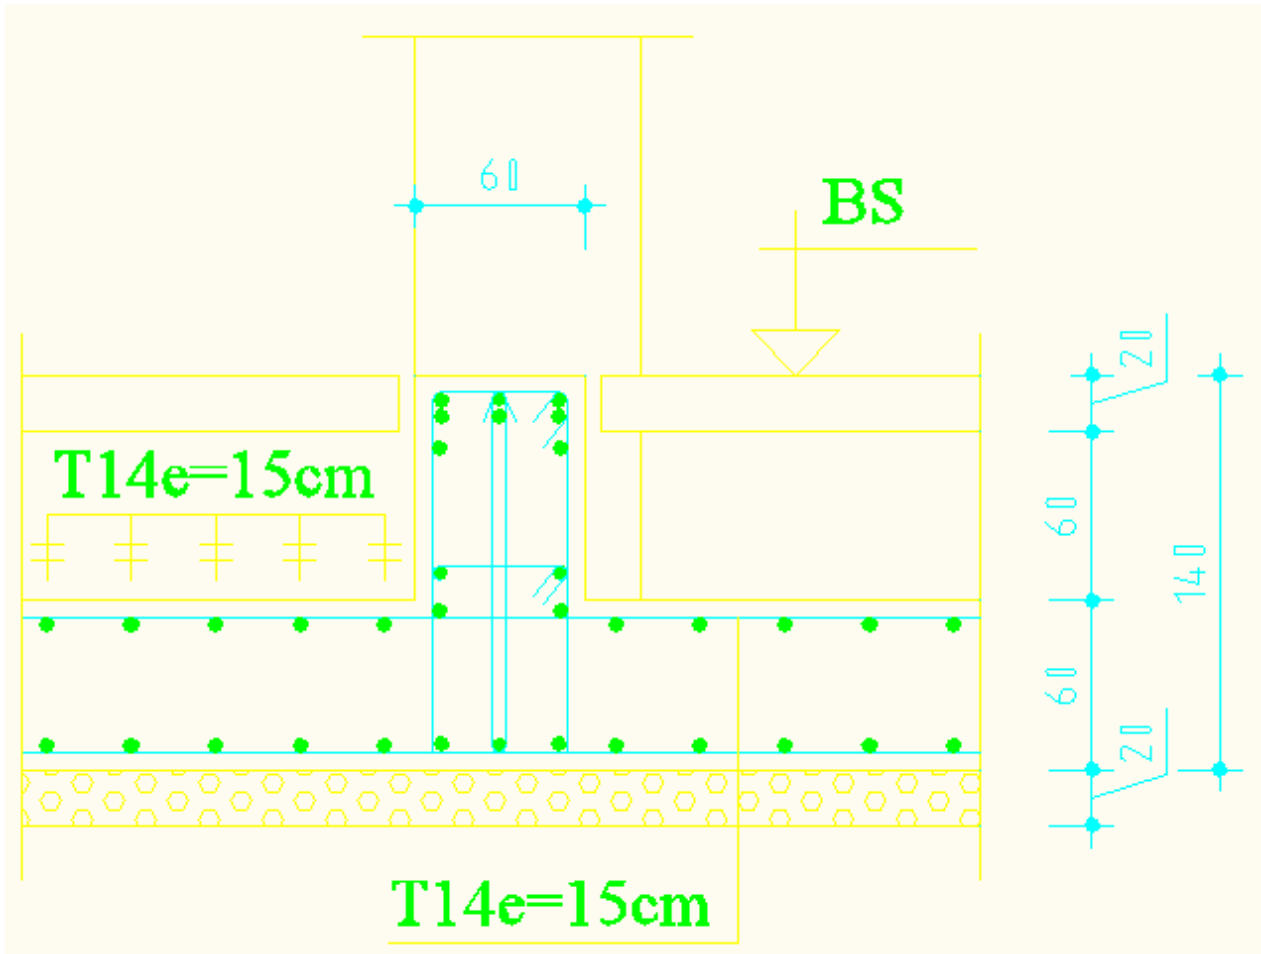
Disposition Ferrailage de Fondation(Radier+Poutre de libarge)
